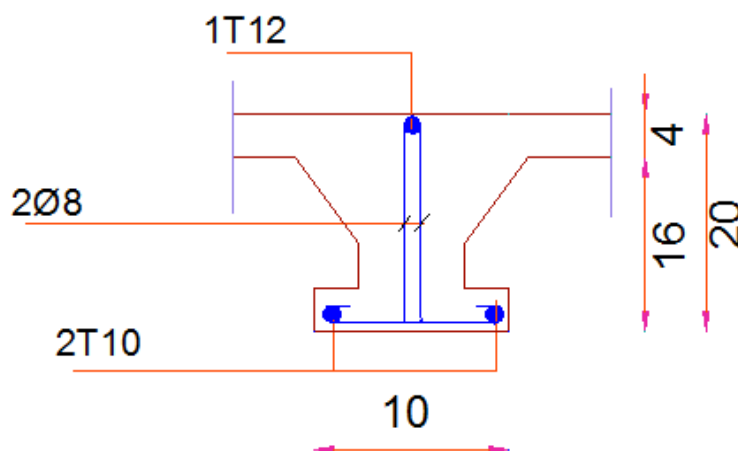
Ferrailage des poutrelles (terrasse et étage courant)
